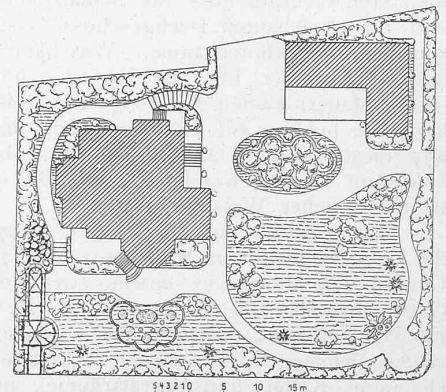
Lageplan der Villa Baumann in Zürich.
